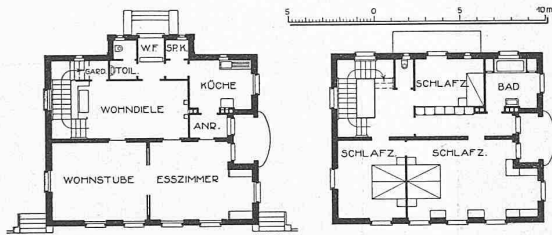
Grundrisse (1 : 400) der Villa Hochuli.
